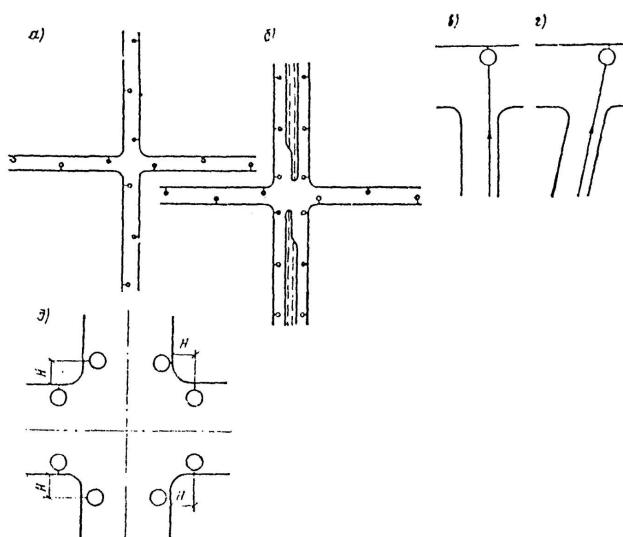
Схемы размещения светильников на пересечениях в одном уровне а, б, д - на четырехсторонних пересечениях; в, г - на примыканиях
